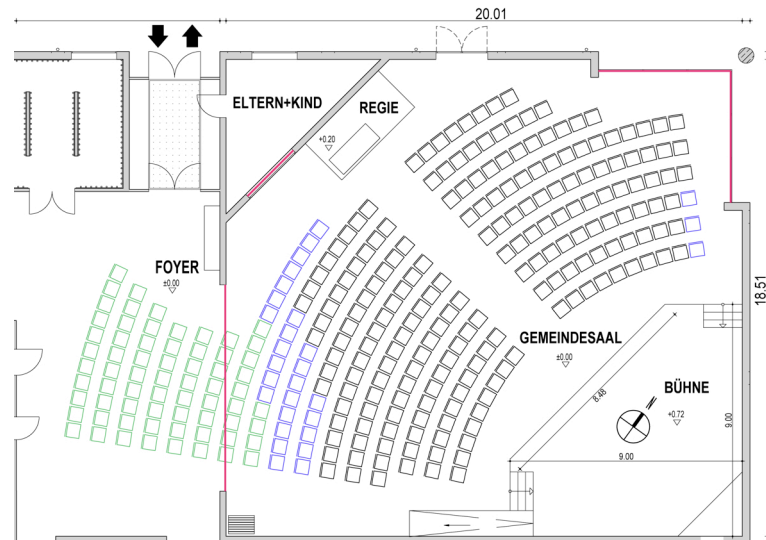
Grundriss mit asymmetrischer Bestuhlung (schwarz und blau), Erweiterung (grün) sowie Glasflächen (rot).²³
